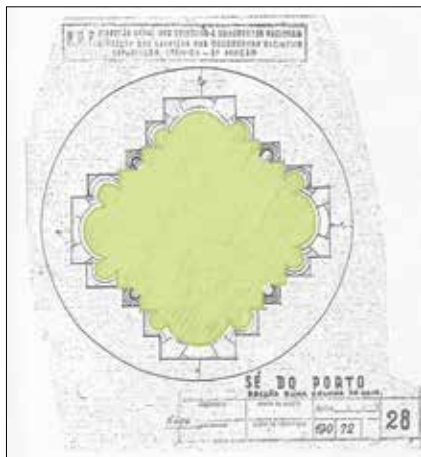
Revisão da planimetria original dos pilares (com menos quatro feixes de coluna)
